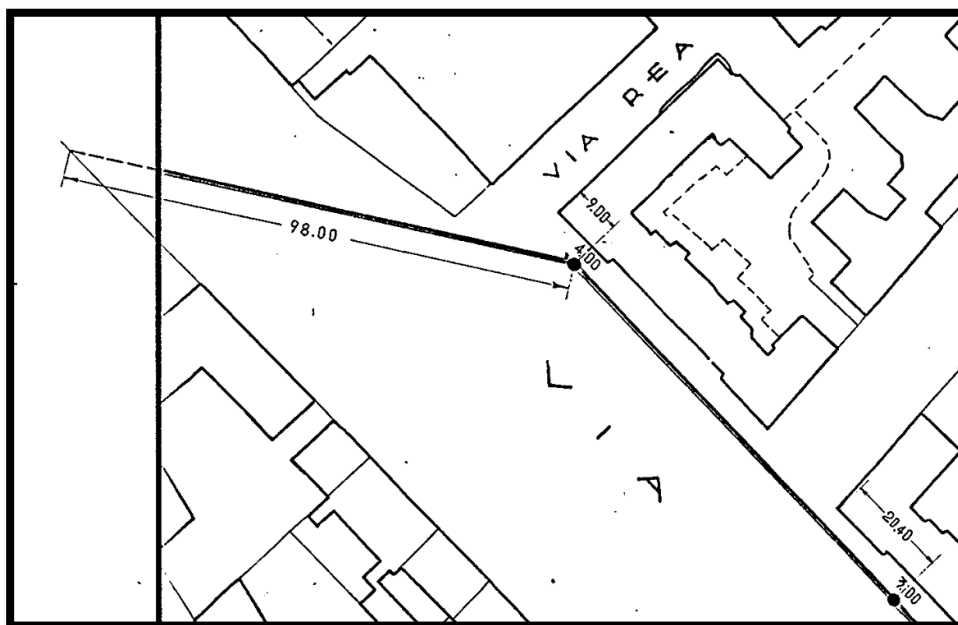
Planimetria storica T.18 cunicolo servizi su Piazza dell'Alberone
